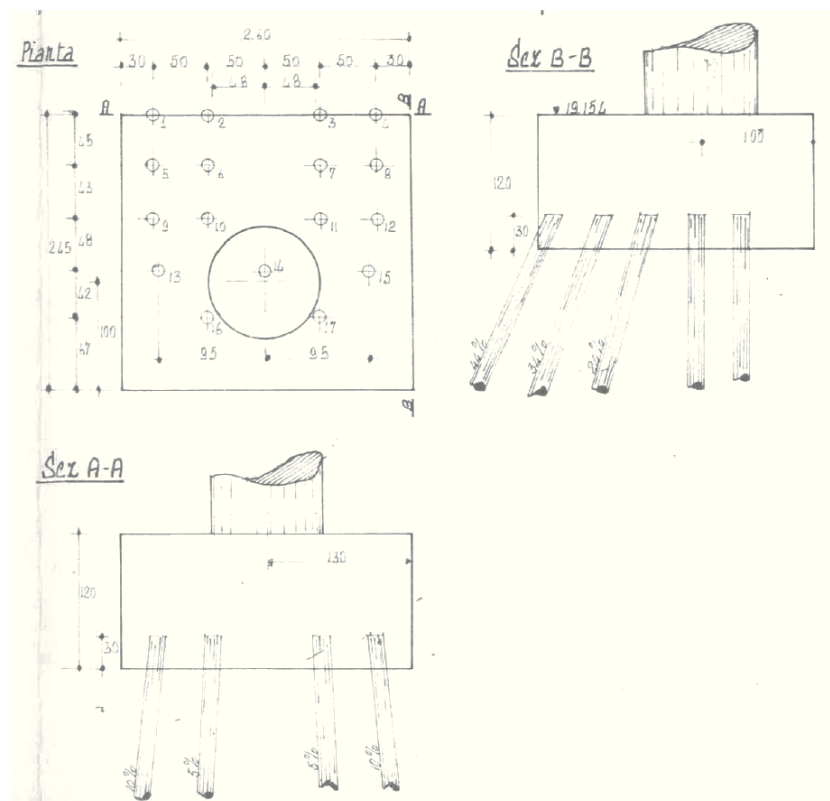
Esempio plinto di fondazione pile esistenti
